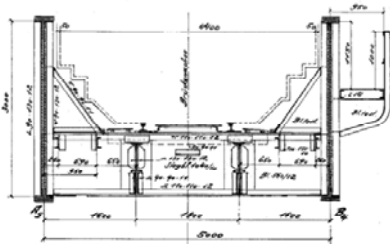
Ponte a travi parallele a parete piena presso Naumburg (Germania) [2]
